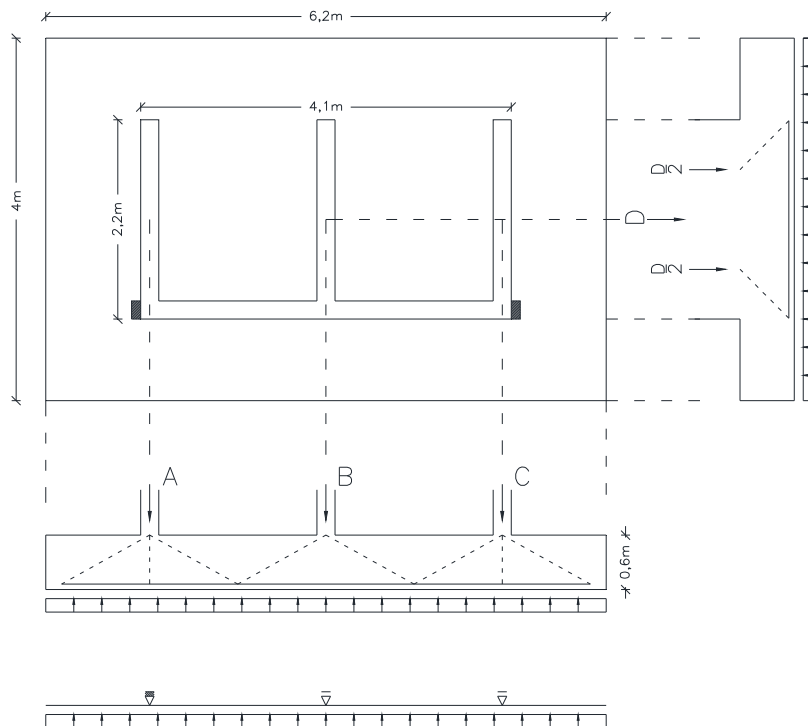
Representação, em planta, da sapata do núcleo de elevadores e modelo de cálculo de armaduras de base
